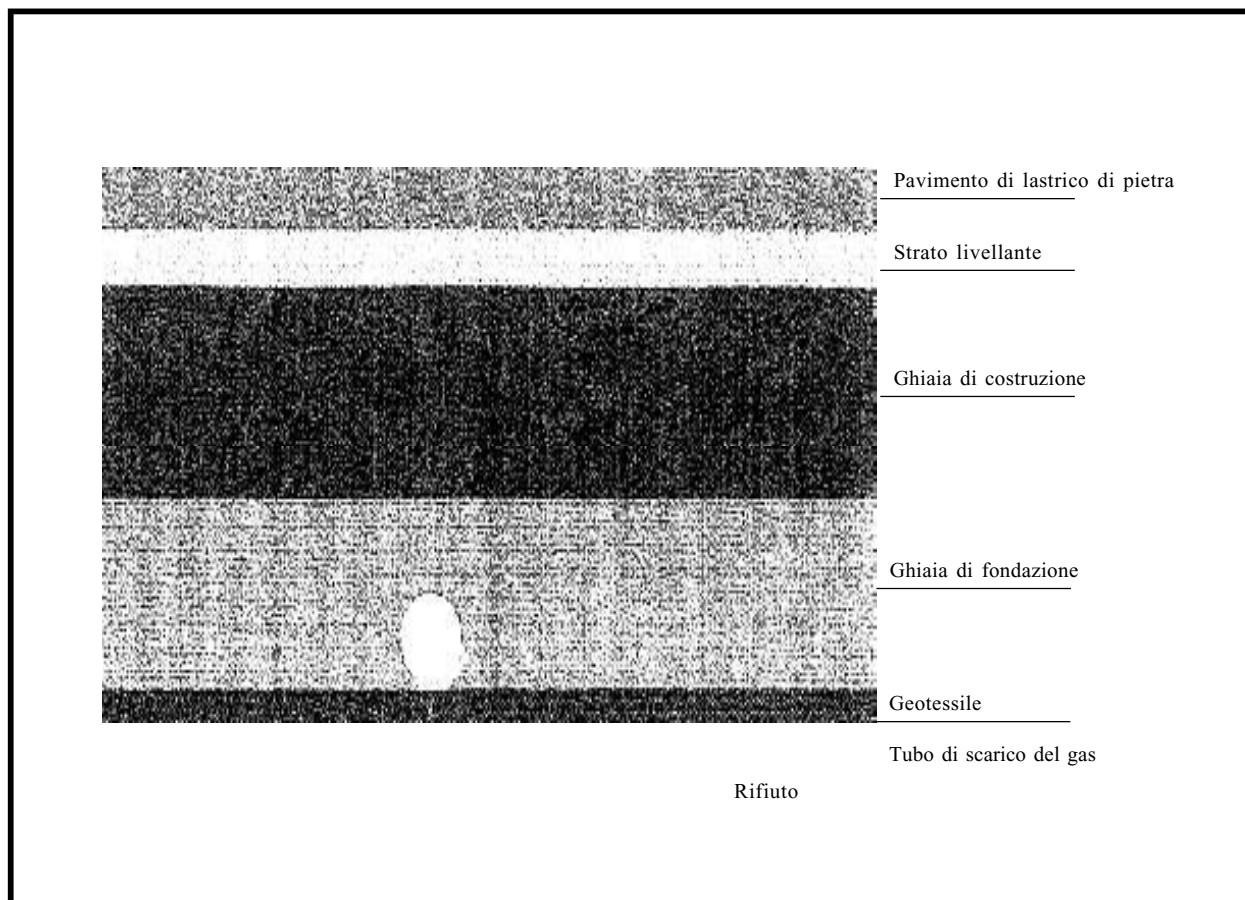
Pavimento e sistema di ventilazione sotto l'area di parcheggio
